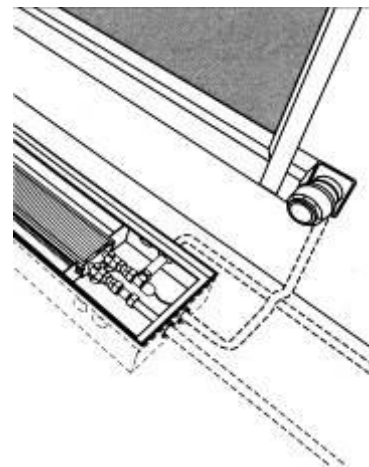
Расположение нагревательного элемента «Mini-Canal» внутри установочной коробки
